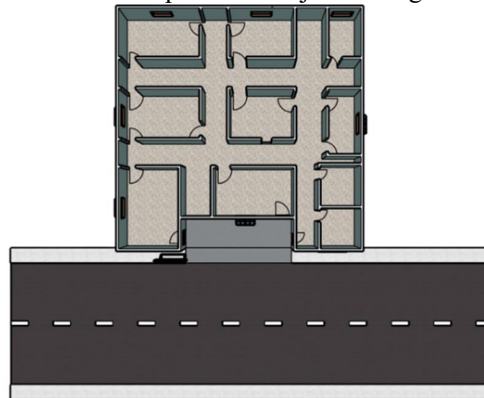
Final Layout* 3D pada UD. Bengkel Bubut Duta Teknik Tampak ISO
